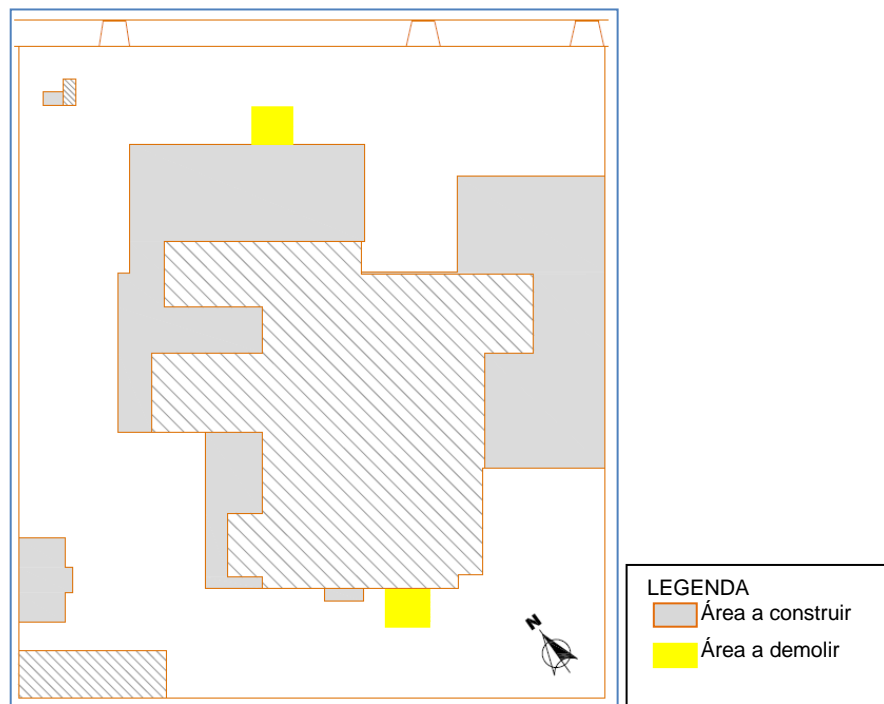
Planta esquemática da área existente, a demolir e a construir.
